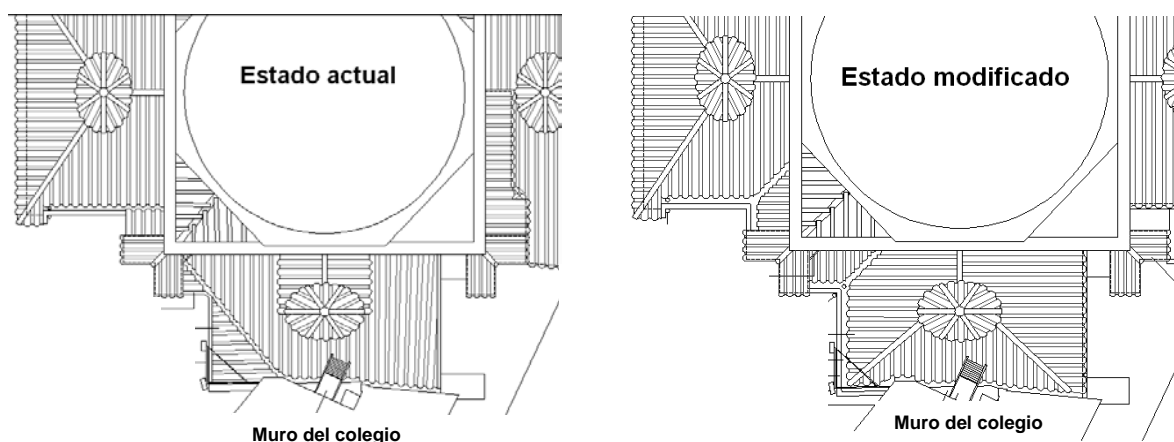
Plantas de cubierta en el estado anterior a las obras y según estaban previstas en el proyecto de restauración
